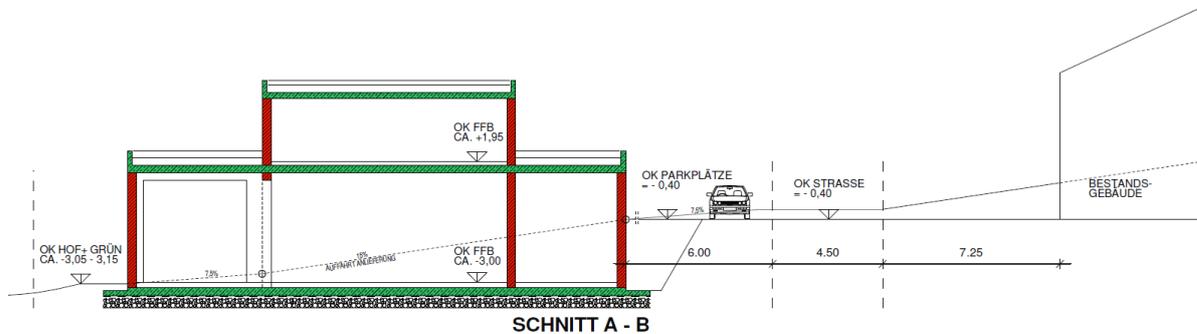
Gebäudeschnitt (Architekt Werner Schaack, Stand: 11.03.2019)
